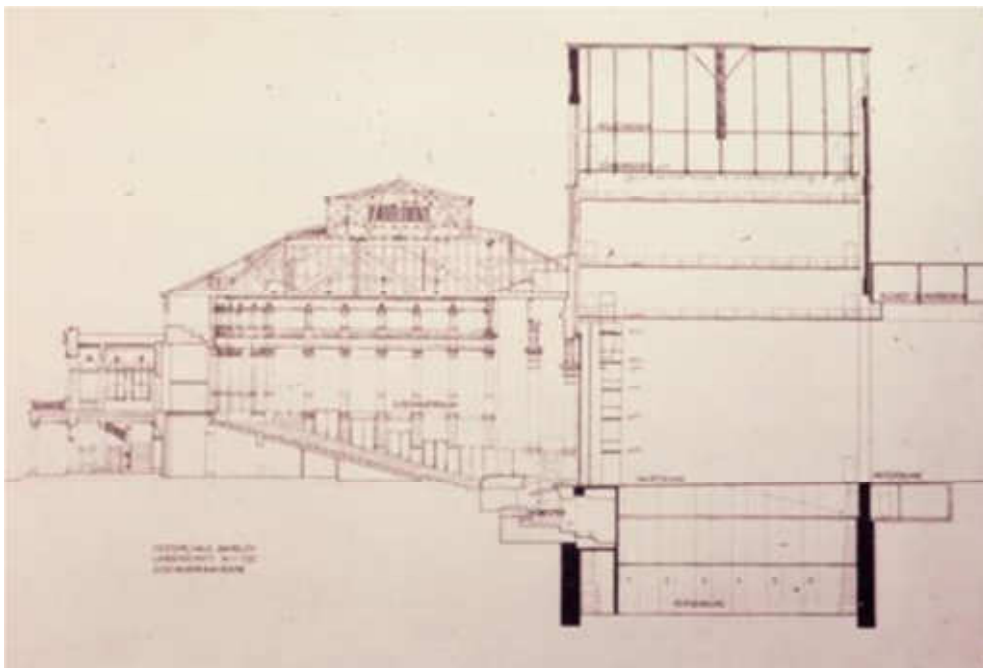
Otto Bruckwald, Bayreuther Festspielhaus, sezione longitudinale, 1876
